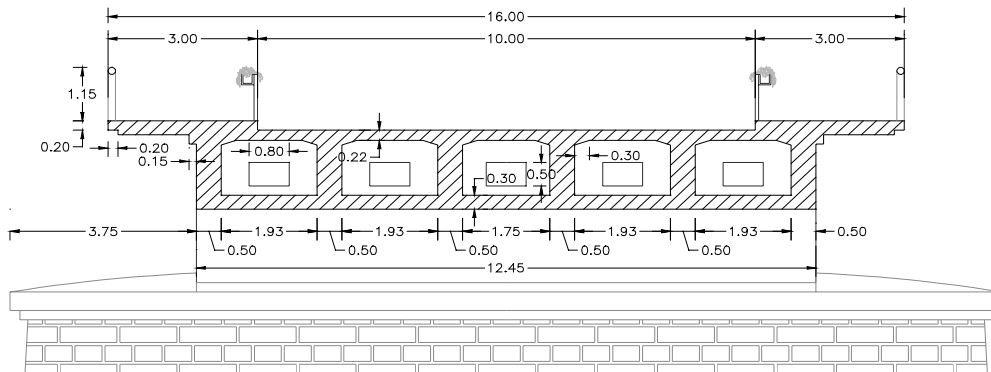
Sezione trasversale dell'impalcato: stato di fatto
